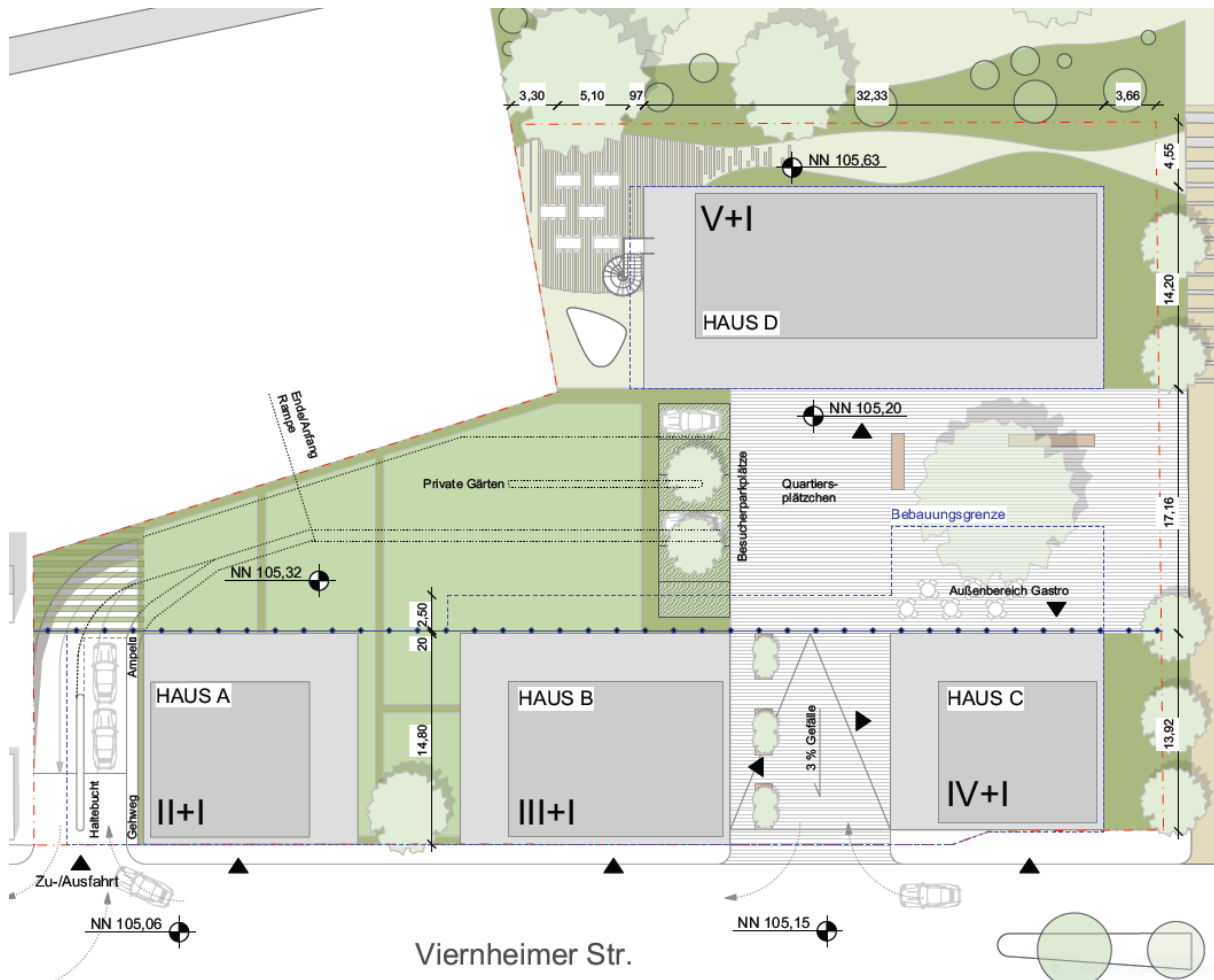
Lageplan Baufeld 3 (Studio SF Simon Fischer & Architekten GmbH für Tröndle Wohn- und Gewerbebau GmbH)
